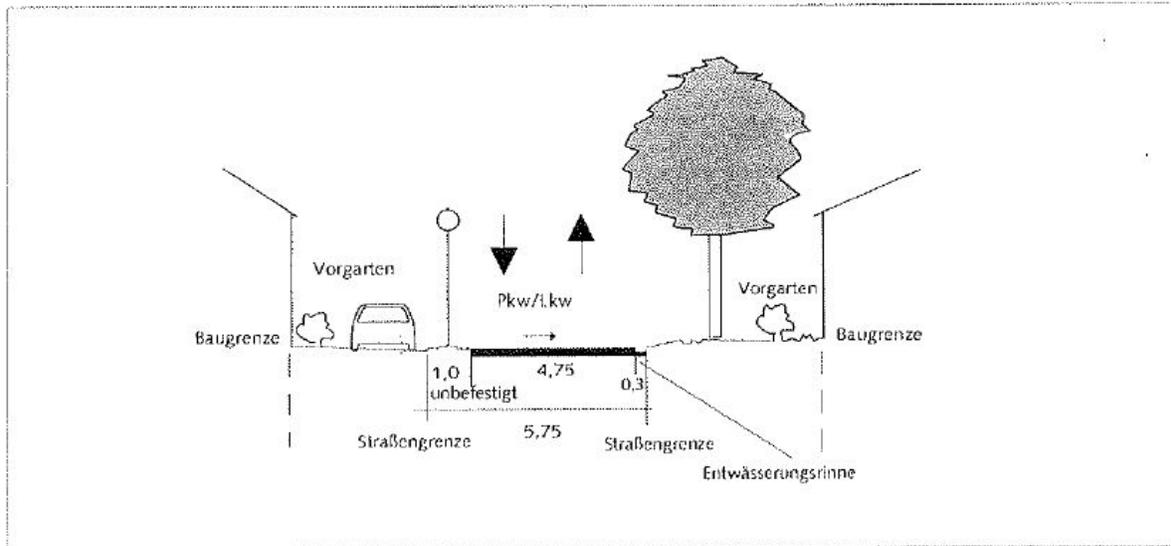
Beispiel für Erschließungsstraße mit Zeichen 325/ 326 (verkehrsberuhigter Bereich) ca. 50 WE angeschlossen, Stellplätze für Anwohner und Besucher auf den Grundstücken. Quelle: Beate 94.
